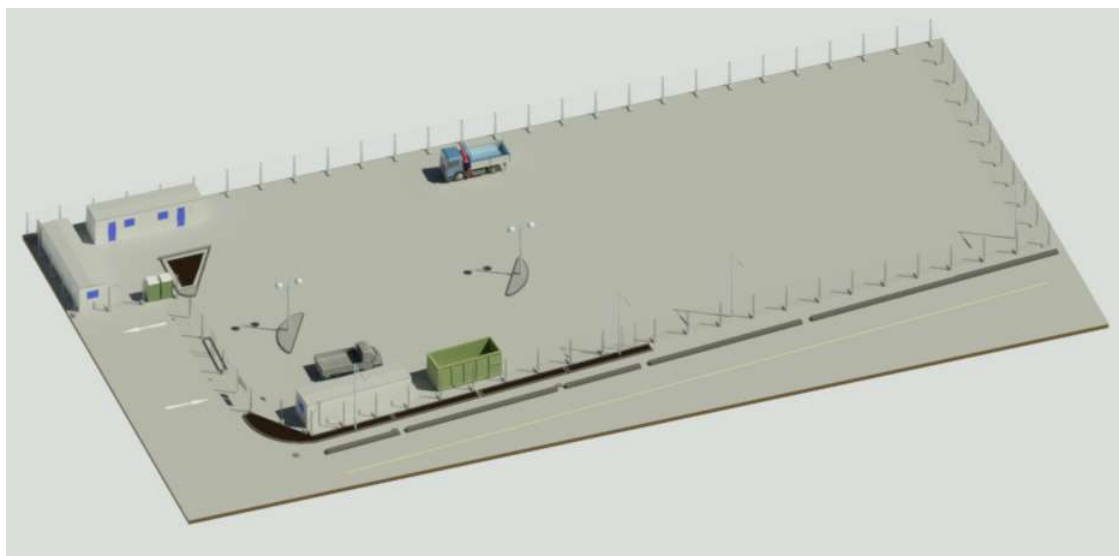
Vista dall'alto dell'area di cantiere.
